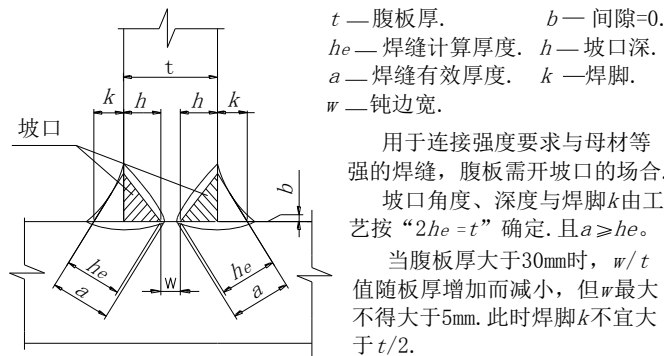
焊缝计算厚度与母材等强的非熔透焊缝
